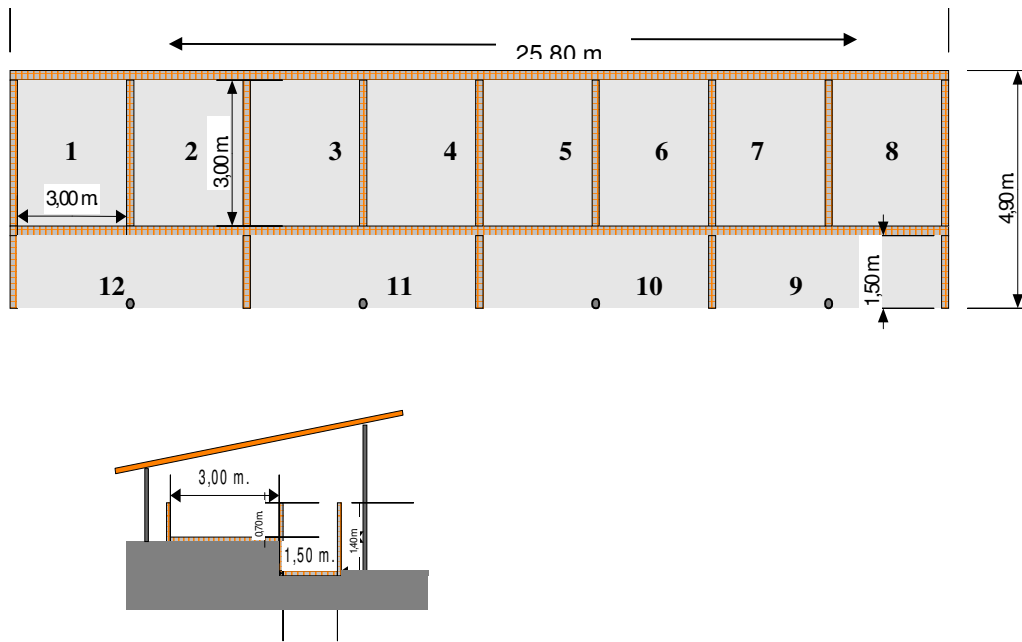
Planta baixa e corte das construções das câmaras de incorporação e compostagem.
